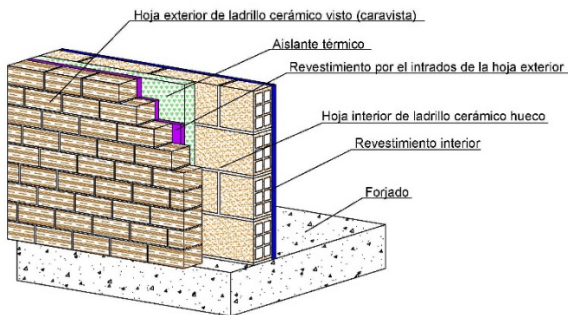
Detalle de fachada caravista de dos hojas. 2015. Fuente propia.
